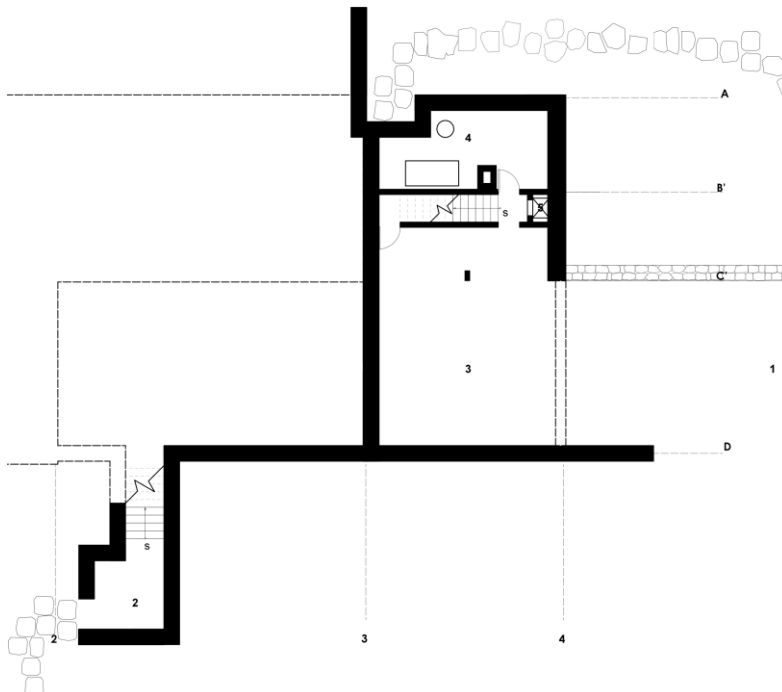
Planta de sótano, zonificación. Fuente: Autor.
